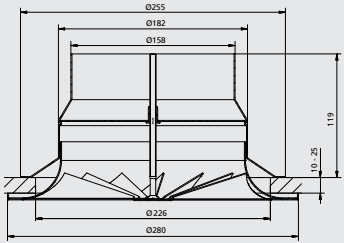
Схематическое расположение принадлежностей из листовой стали для потолочного монтажа
